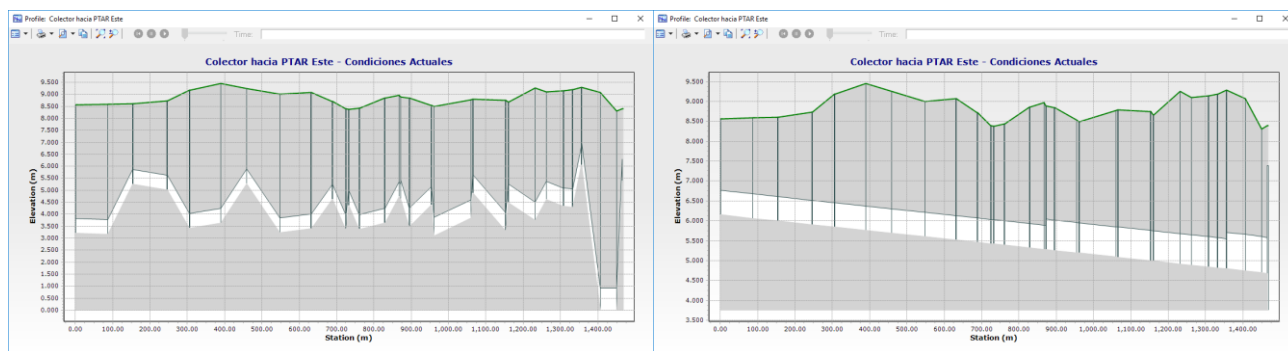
Perfiles con plantillas originales y con plantillas redefinidas.
